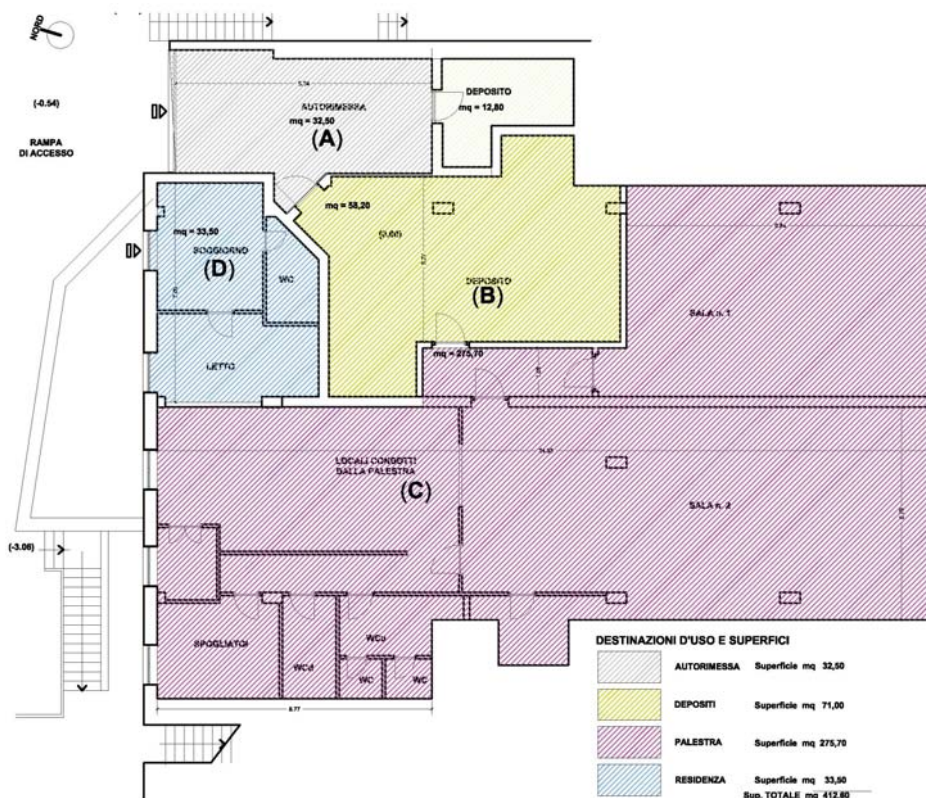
Planimetria del SUB 14 (EX SUB 10) al piano terra
